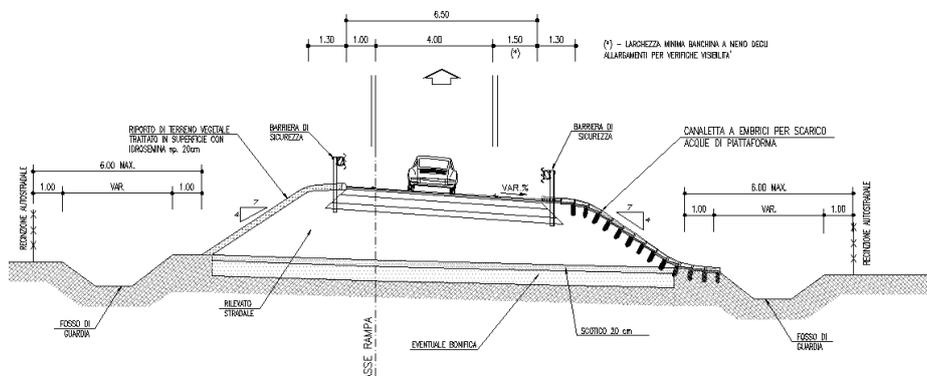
(b) – Sezione tipo nuova rampa di svincolo monodirezionale
